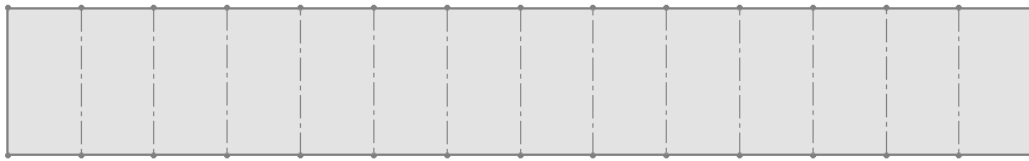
Vista de planta del modelo del edificio de boxes; con separación para cada box.
